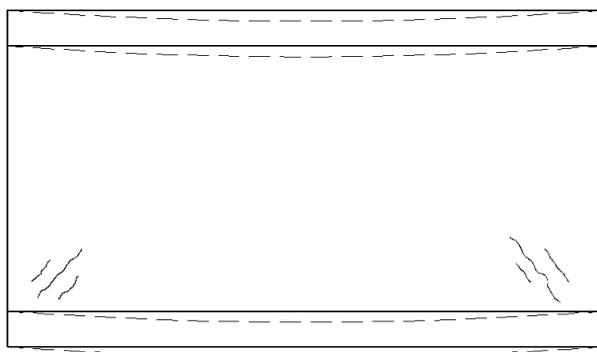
Fissuração causada pela deformação das vigas superior e inferior (Fonte THOMAZ, 1989)
